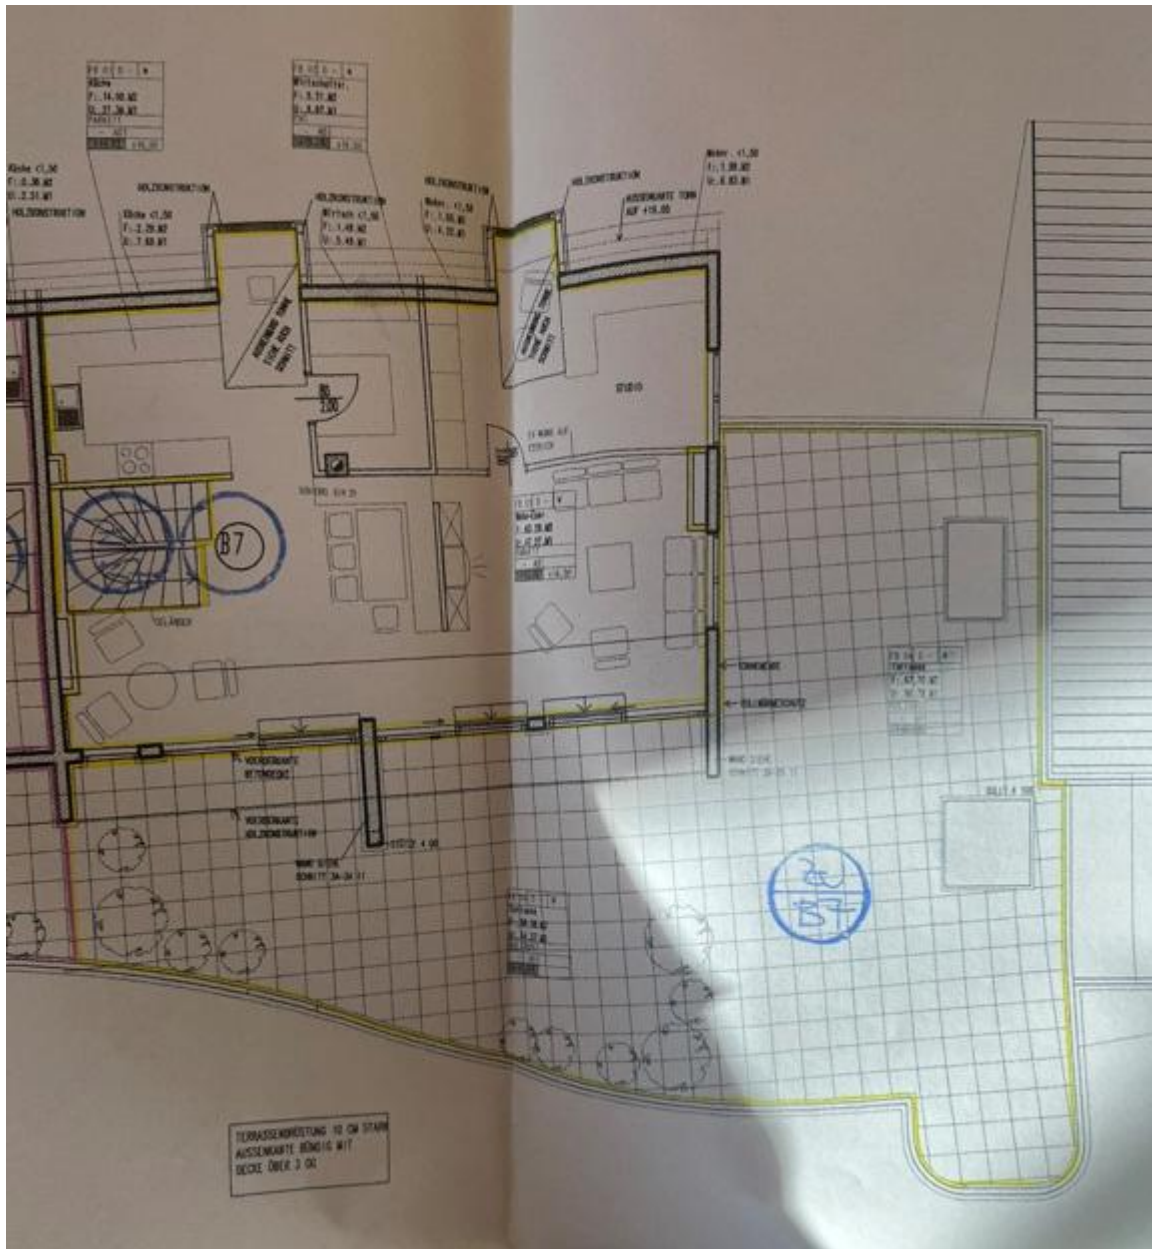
Grundriss Top B7 (Dachgeschoss<sup>10</sup>)
